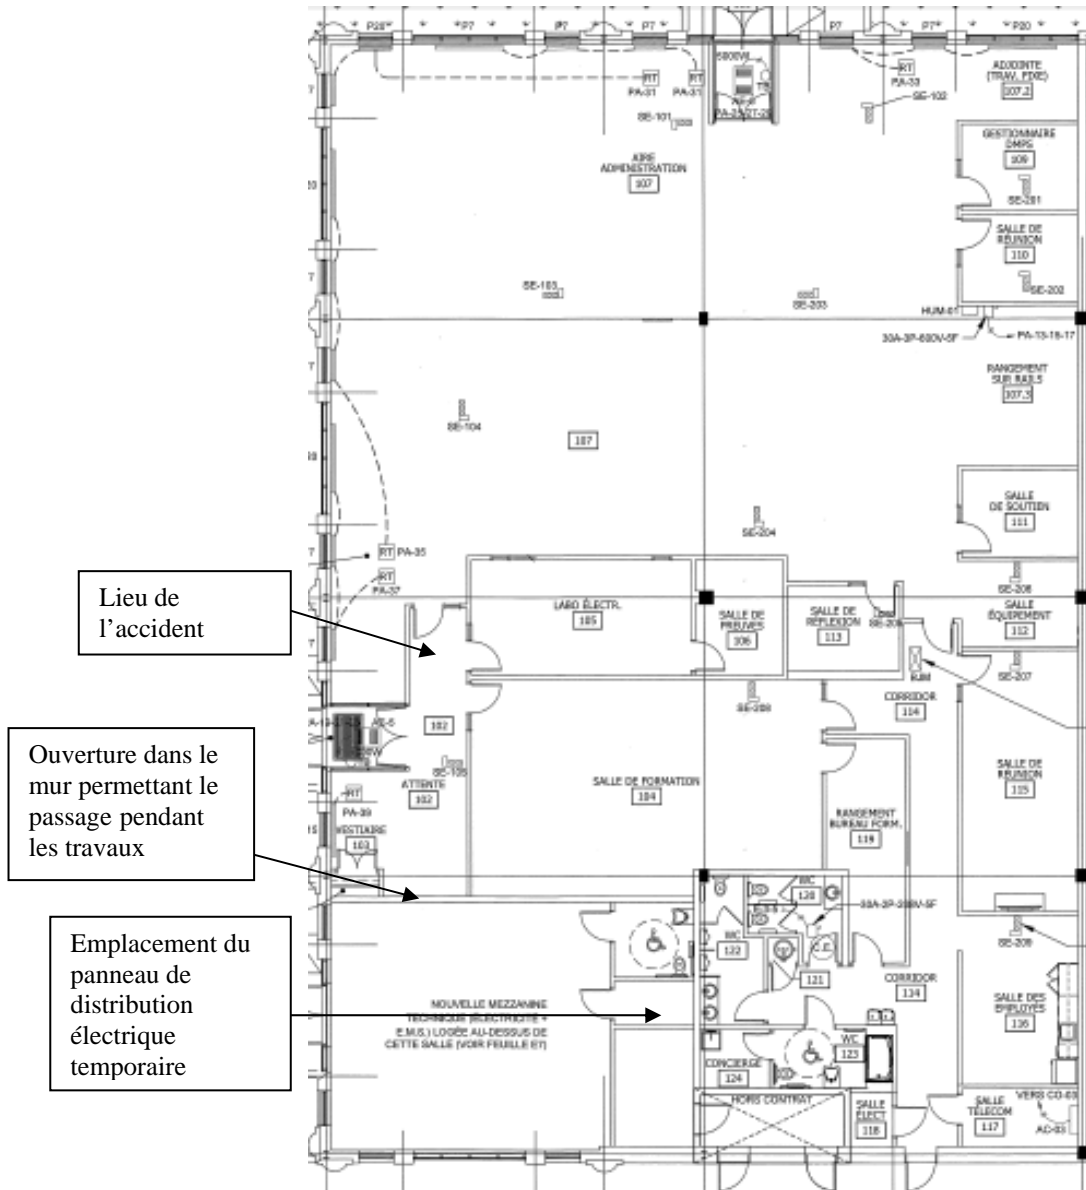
Plan du lieu de travail (Source : Rénovations Olympec inc.)
